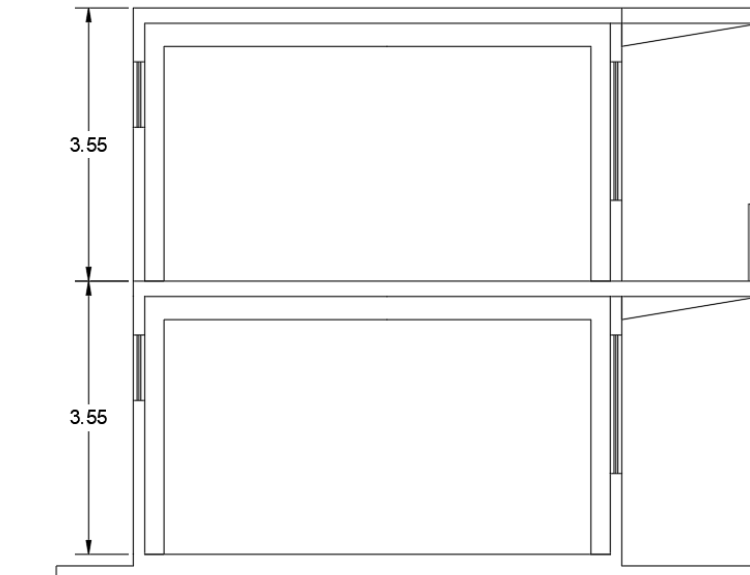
Sistema estructural de ejes 2-2, 4-4.
